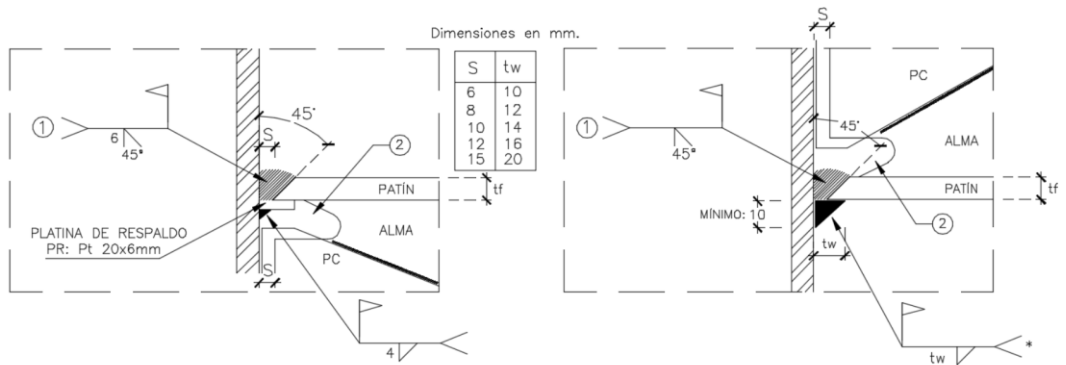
Detalle de soldadura en patines de vigas sísmicas
